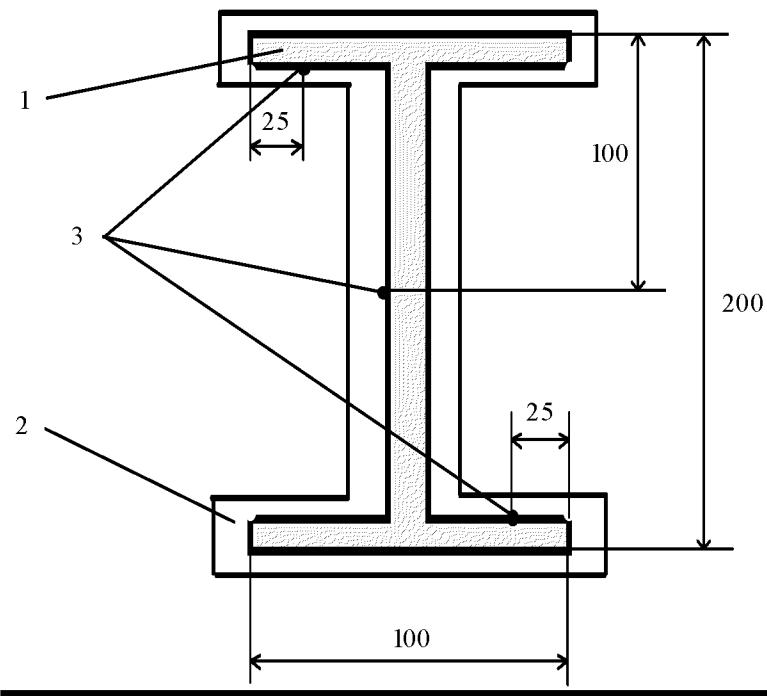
Схема установки для огневых испытаний стержневых конструкций
